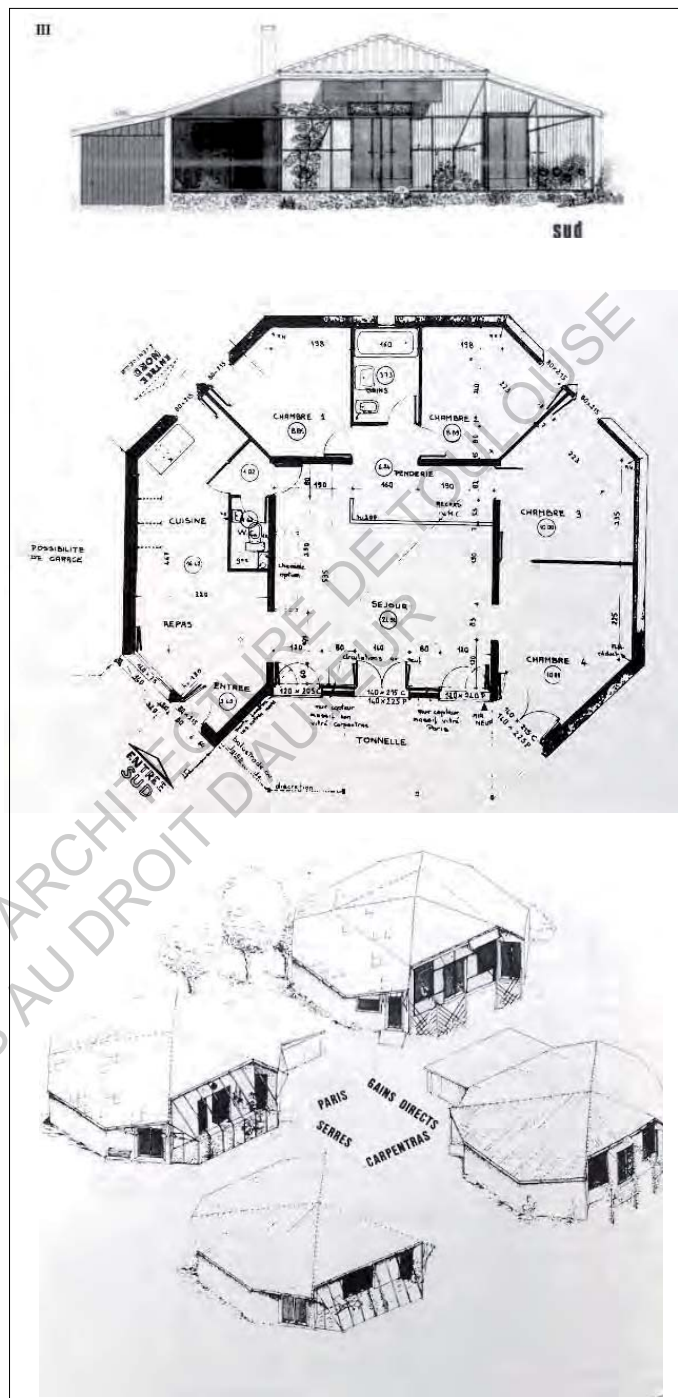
Elevation, plan et axonométrie de la maison Marjolaine, construite en 1982
